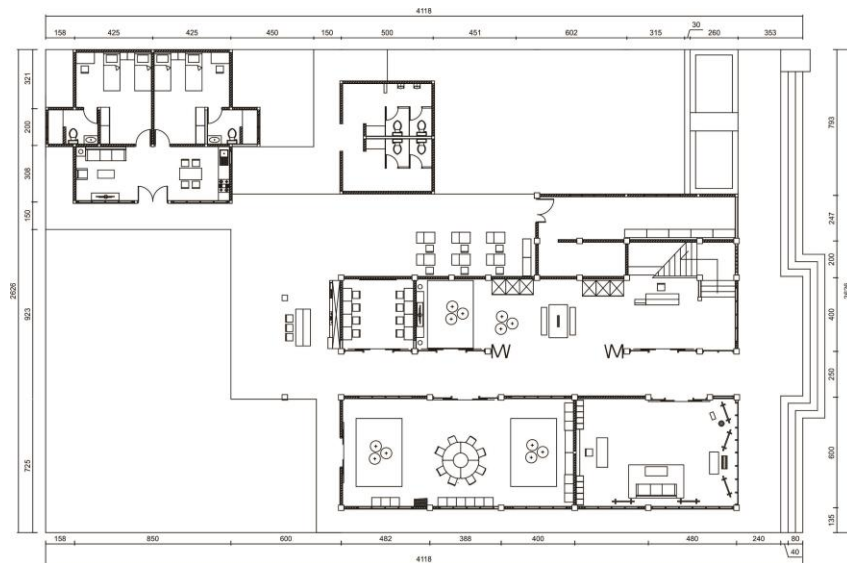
Zoning dan sirkulasi alternatif 2 lantai 2
